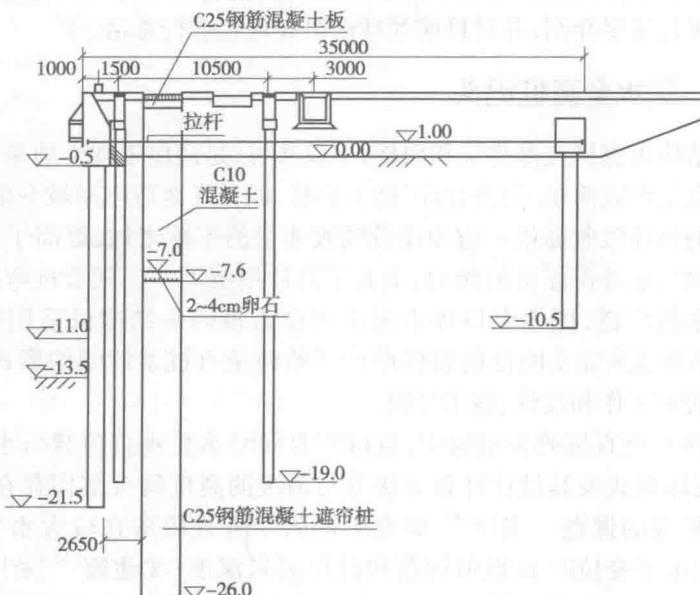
遮帘式板桩码头结构断面图(尺寸单位:mm)
